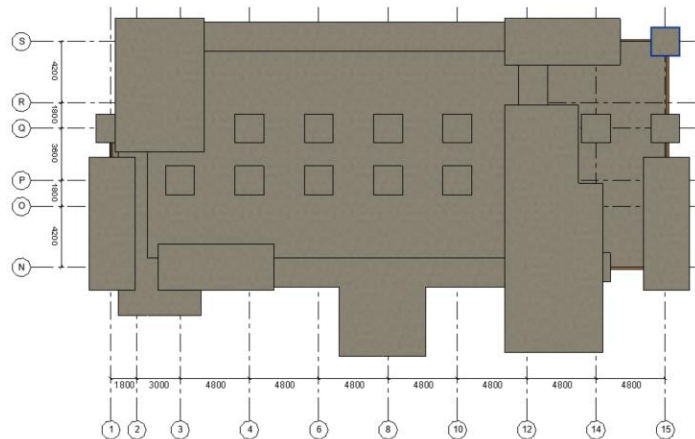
Illustrasjon av typisk løsning for midterste søylerekke i konstruksjonen plan 0. Vedlagt i Zip – fil: Revitfiler – Punktfundament søyle bjelke med armering.
